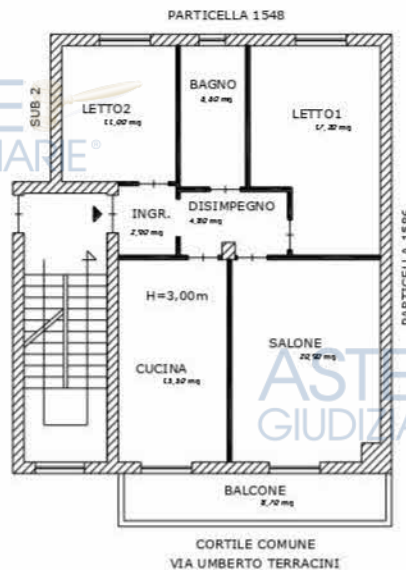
planimetria dell'appartamento al secondo piano interno n.3
